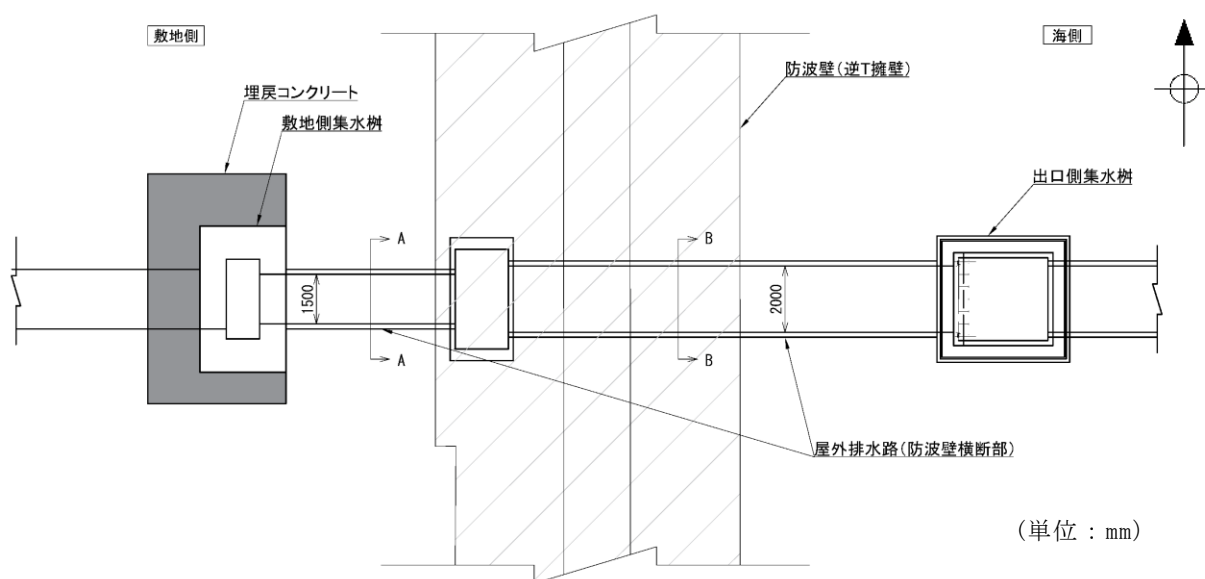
屋外排水路（防波壁横断部）の概略平面図
